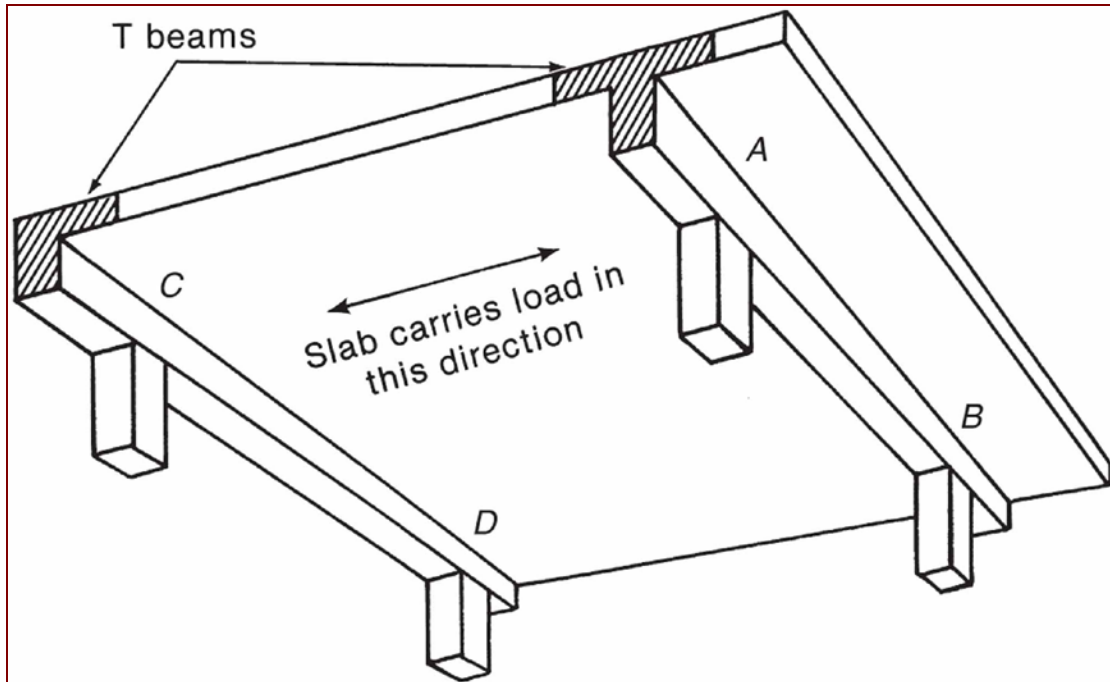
Vigas T en un entrepiso de formado por vigas y losa en una dirección.
